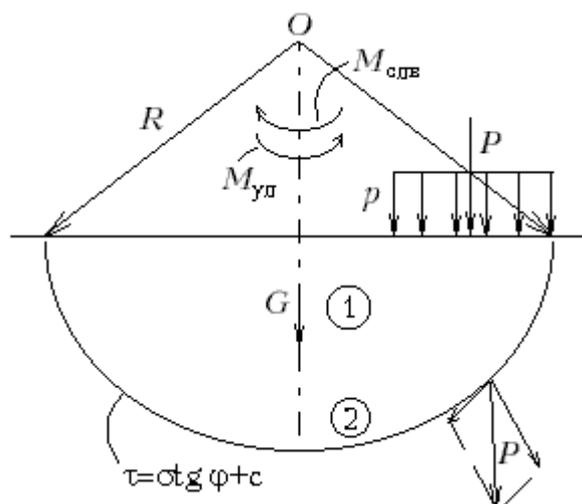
Схема для расчета предельной нагрузки в предположении образования круглоцилиндрических поверхностей скольжения
